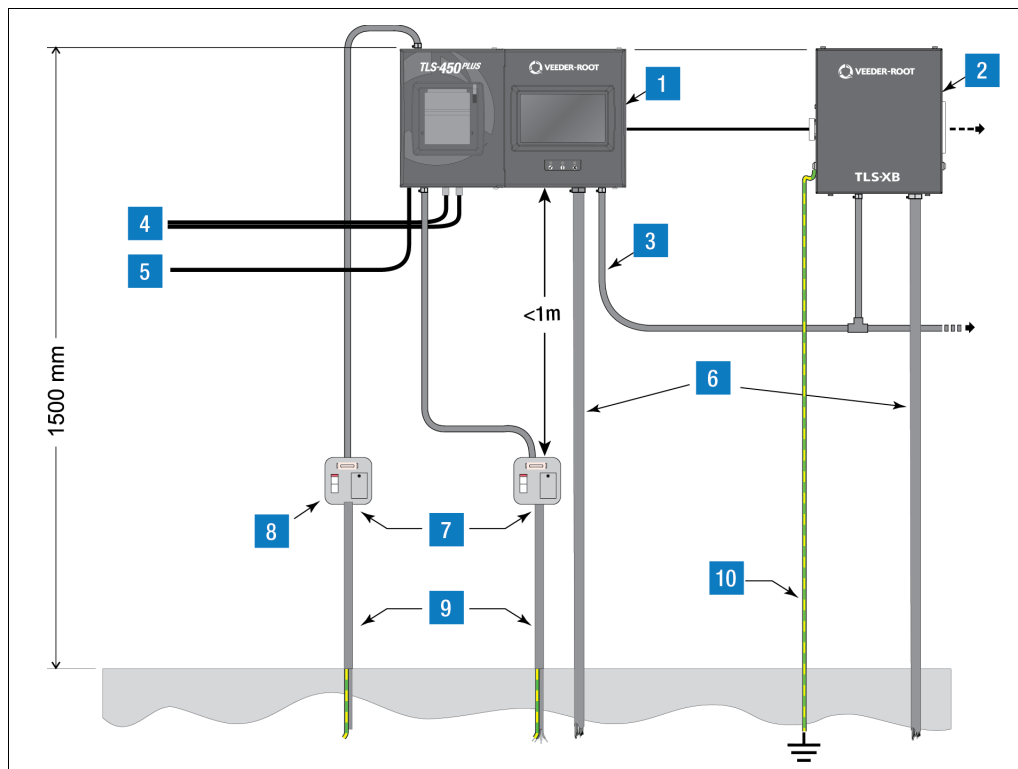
Esempio console TLS-450PLUS/8600 con installazione TLS-XB
